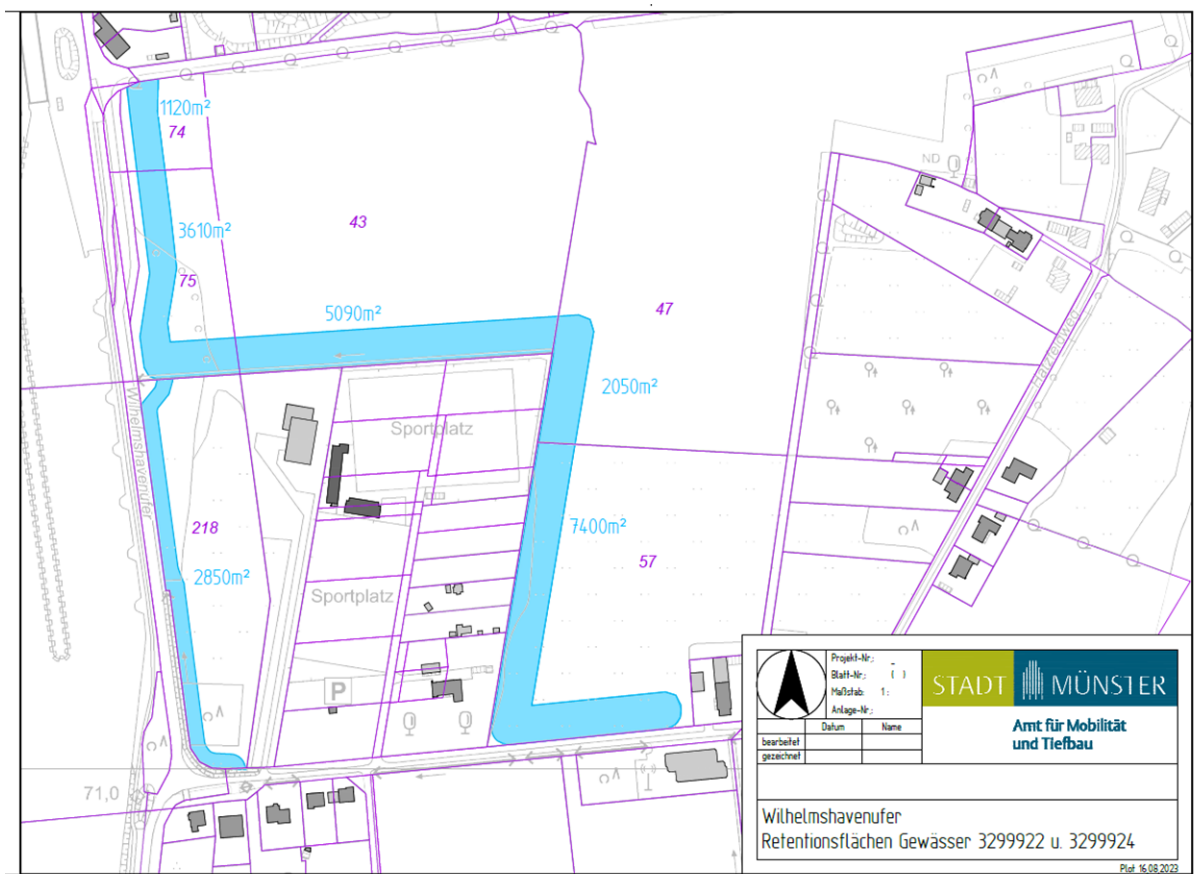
Retentionsflächen Gewässer 3299922 und 3299924 - Hellblau: geplanter Gewässerverlauf
